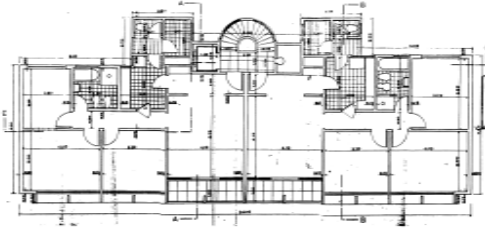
Planta do pavimento-tipo do edifício Santa Terezinha, de Holanda de Mendonça (1950).
